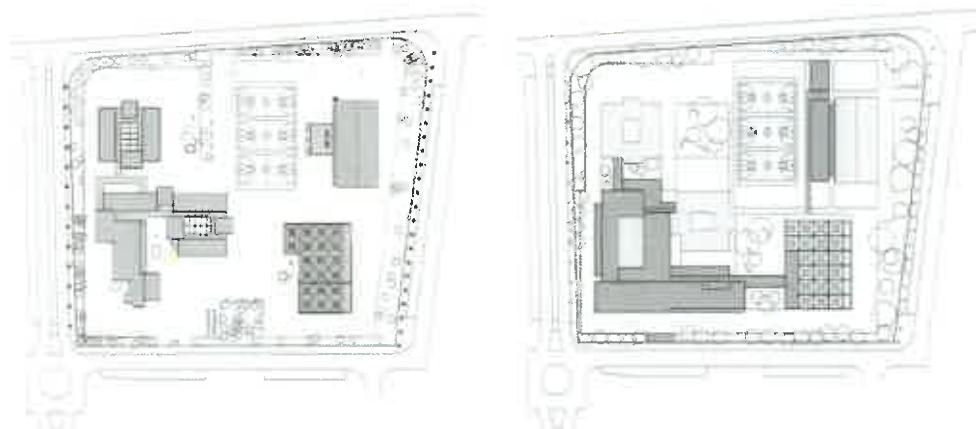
Esquerda: Plano do Existente; Direita: Plano da Proposta
